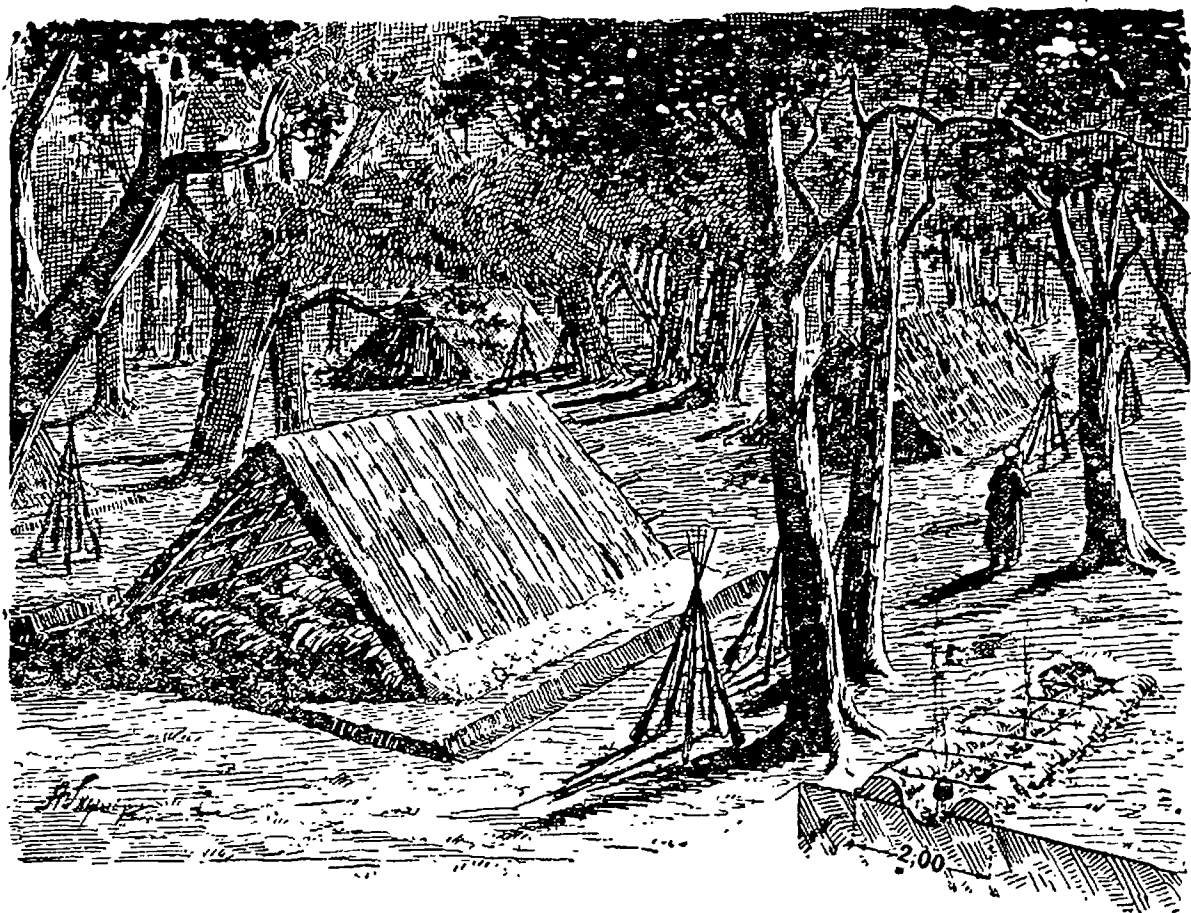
Устройство шалашей и очага для варки пищи в котелках.
